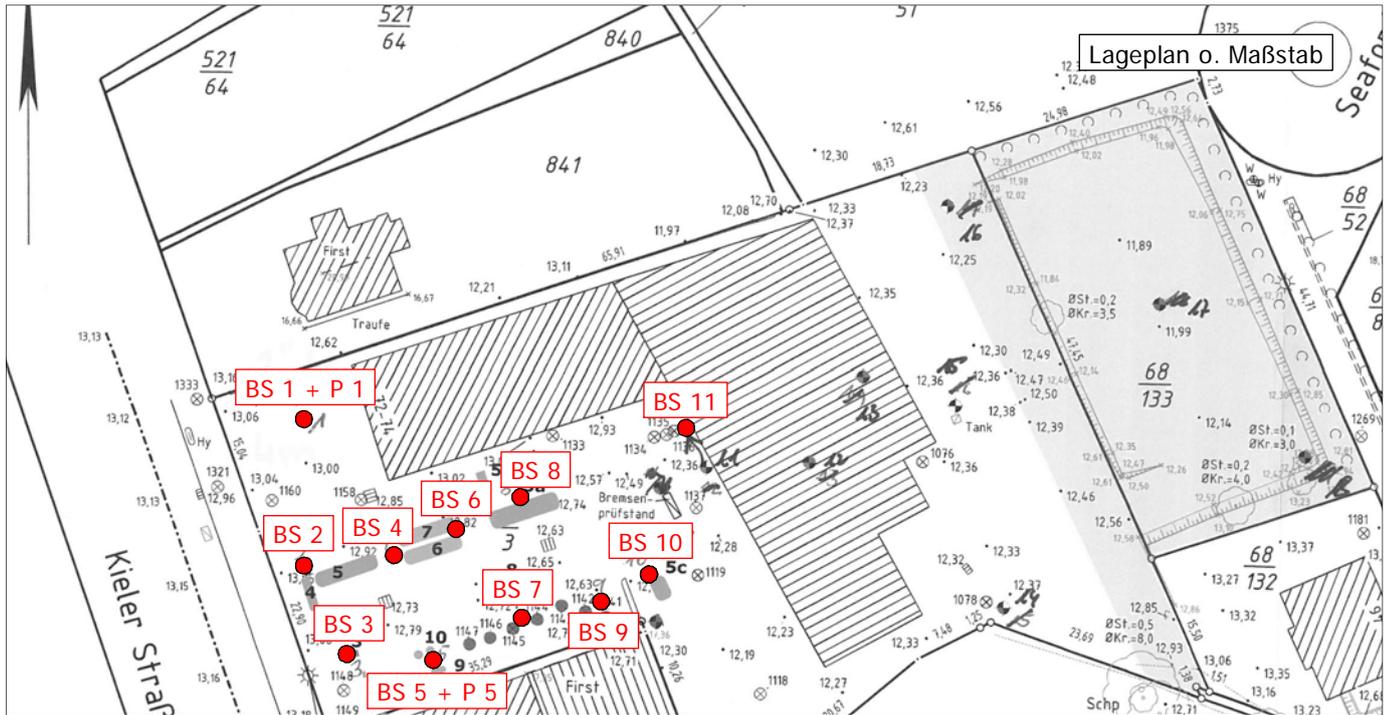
Lageplanausschnitt, s. Anl. 1.1 (o. M.)
